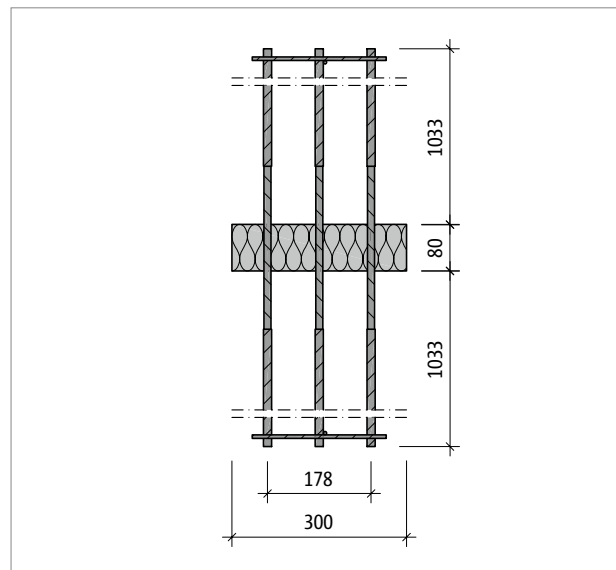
Schöck Sconnex® type W-T1-LW : coupe B-B du produit
